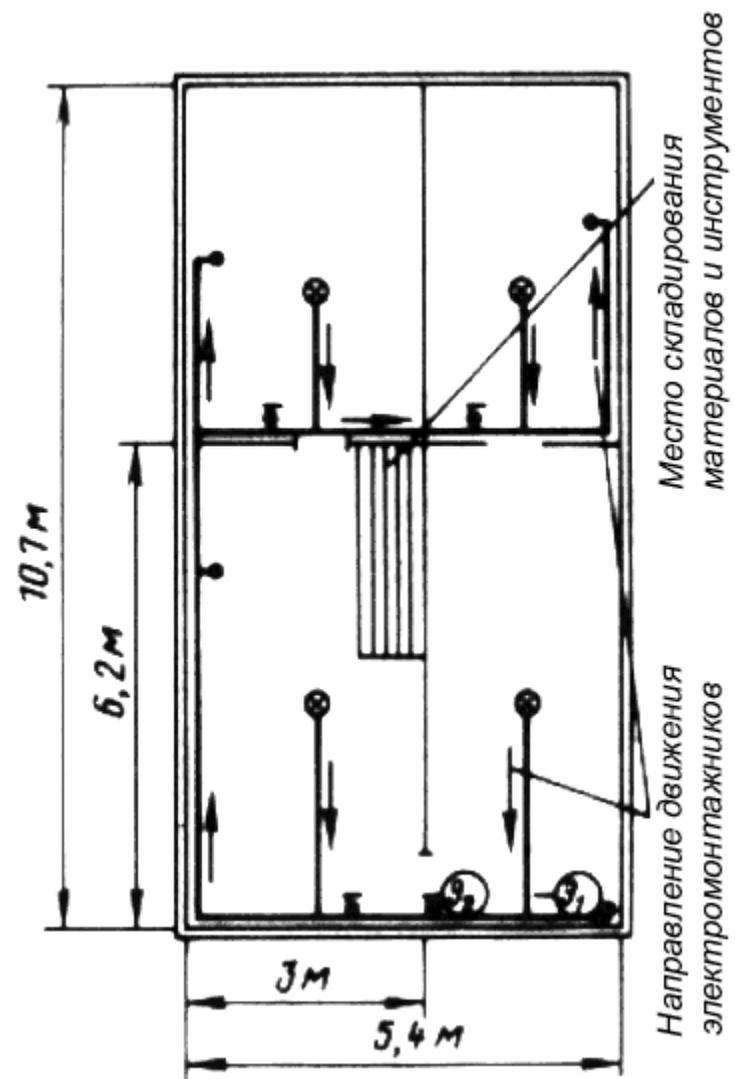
Схема организации рабочего места при монтаже скрытой электропроводки
